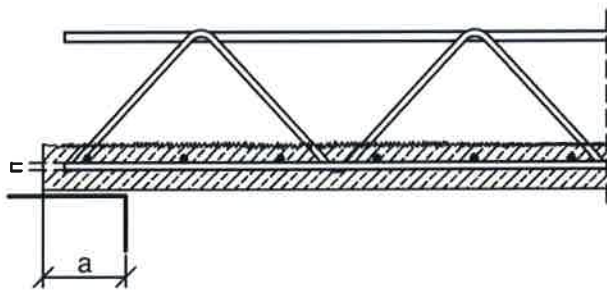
Beispiel Streifenelemente mit Betonstahl
